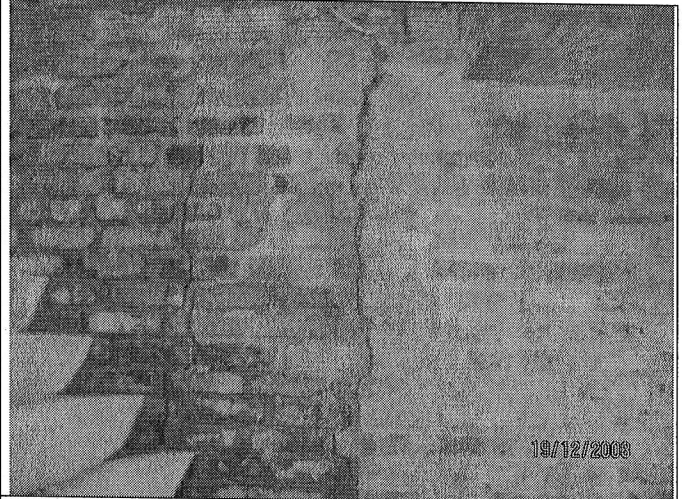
Fisura en muro, presentada en el costado sur del la vivienda de aproximadamente 1cm de ancho, localizada en el lote 15 de la manzana 18 del sector (De acuerdo a la Figura 1)
